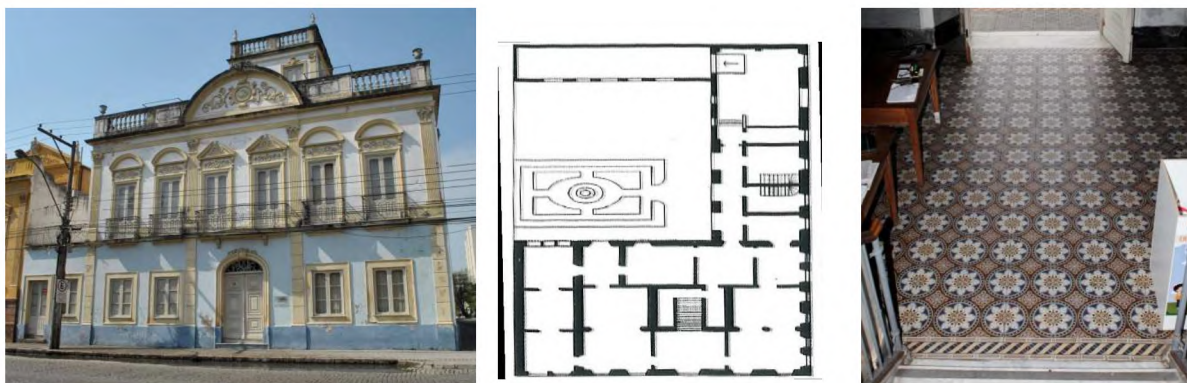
À esq., fachada do casarão nº 2, ao centro planta baixa, à dir., vista geral do hall de entrada.
